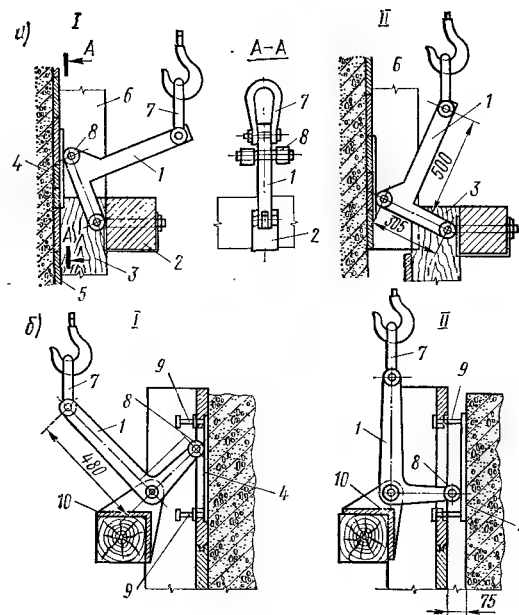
Рычажное приспособление для снятия крупнощитовой опалубки:
